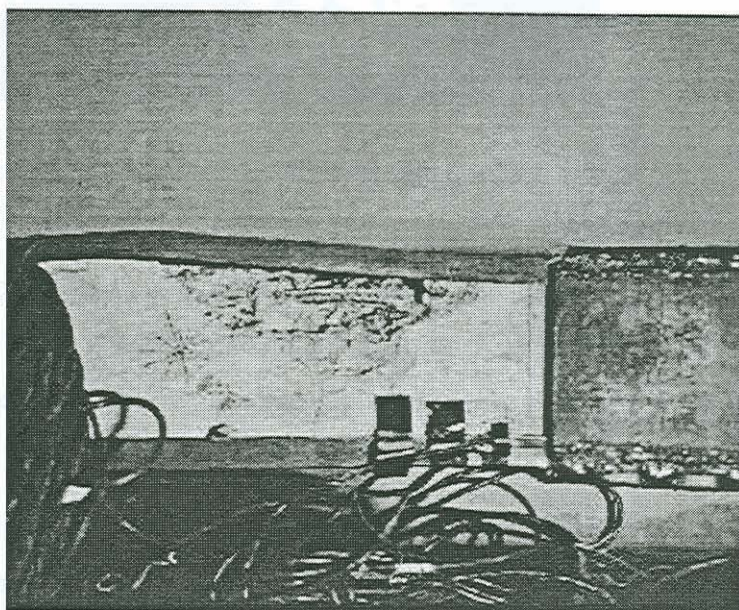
Detalhe da flambagem da cantoneira e da armadura longitudinal.
